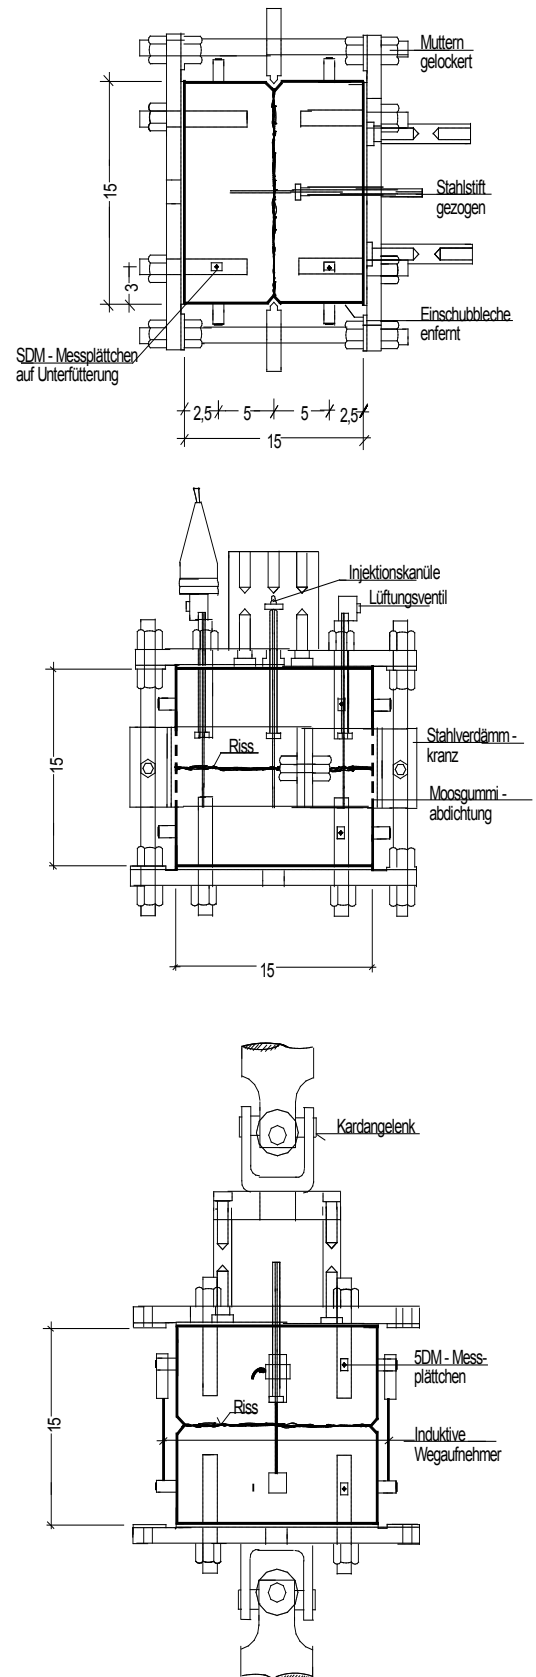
(H) - Prüfstück 3 Einkornbetonzylinder
